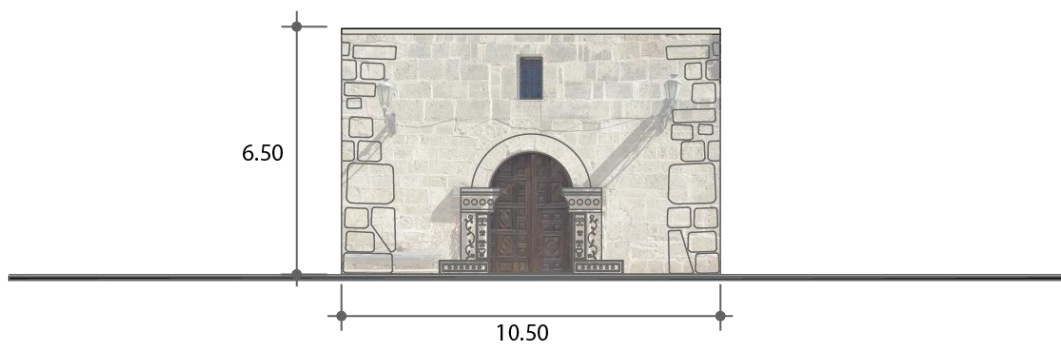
Alzado de etapa constructiva de finales del siglo XVI. Elaboración propia.
